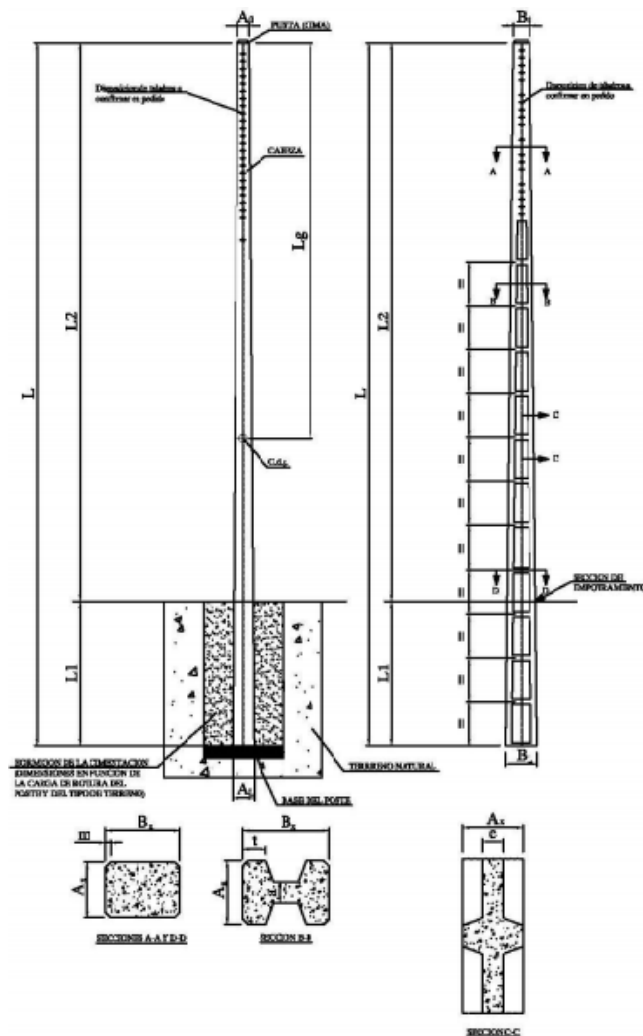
Dimensiones de poste de hormigón pretensado de secciones rectangulares tipo “HC”
